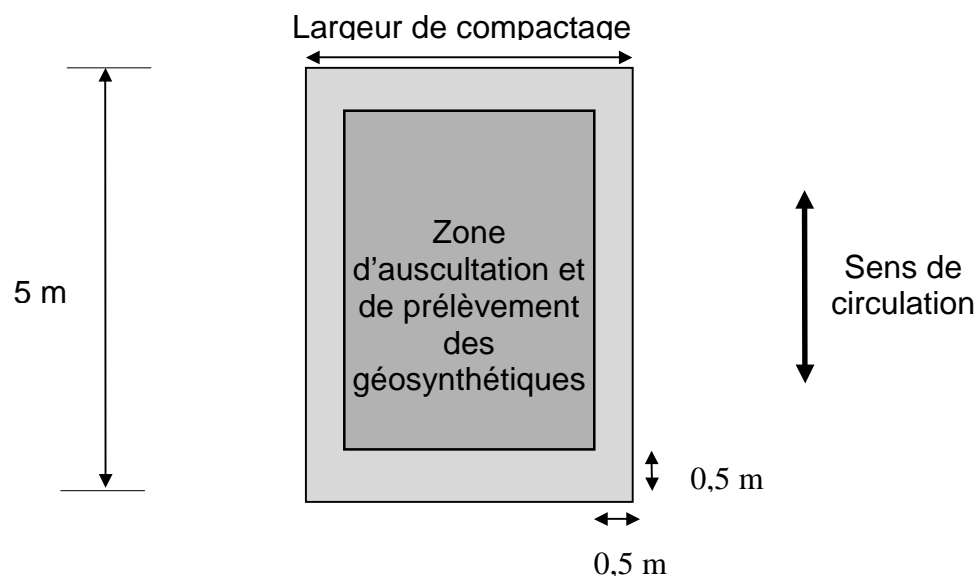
Exemple de planche d'essai (dimensions indicatives)
